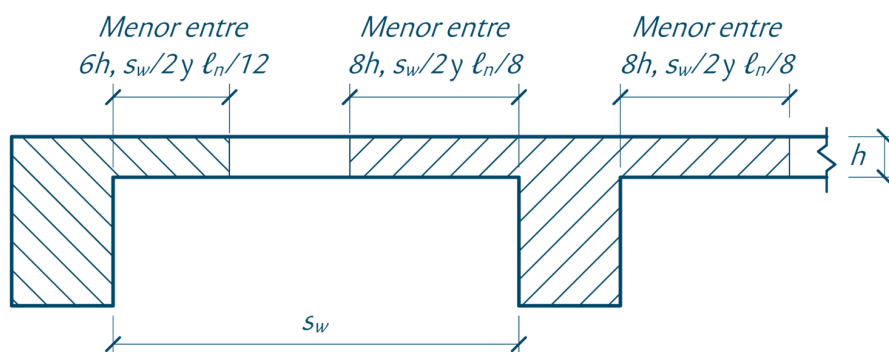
Geometría del ala efectiva en vigas T. Referencia: 5.9.8.
